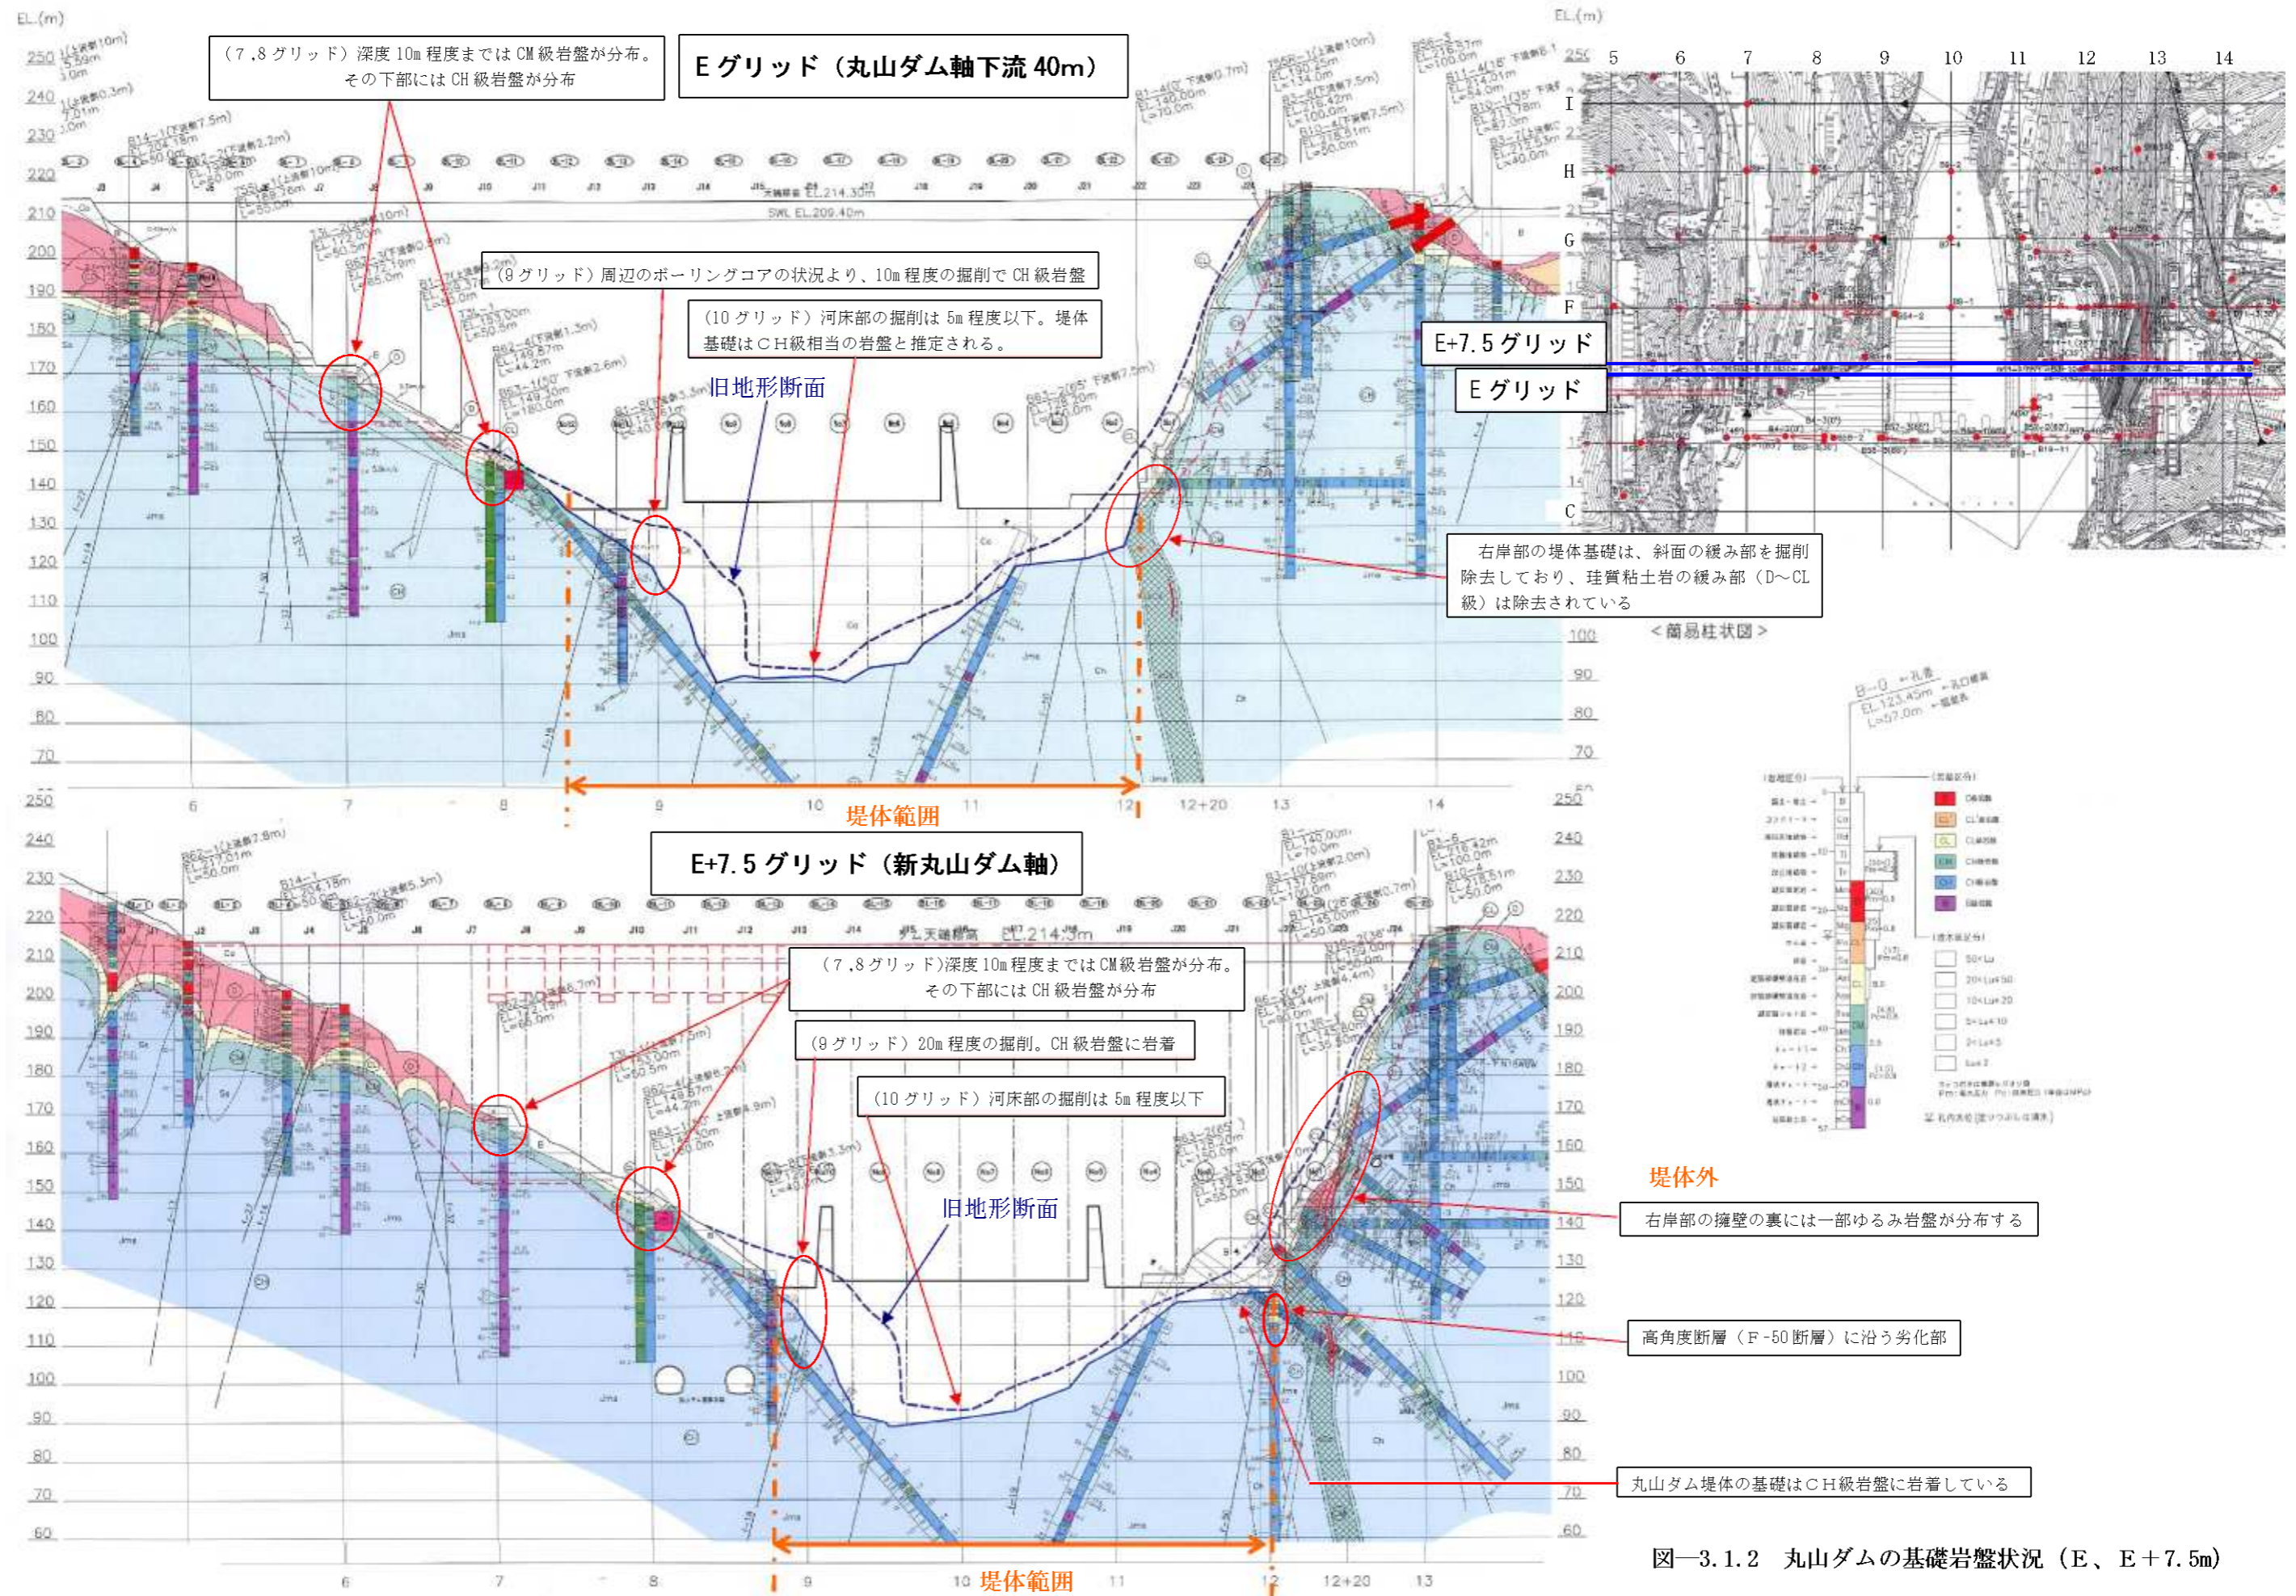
丸山ダムの基礎岩盤状況 (E、E+7.5m)
